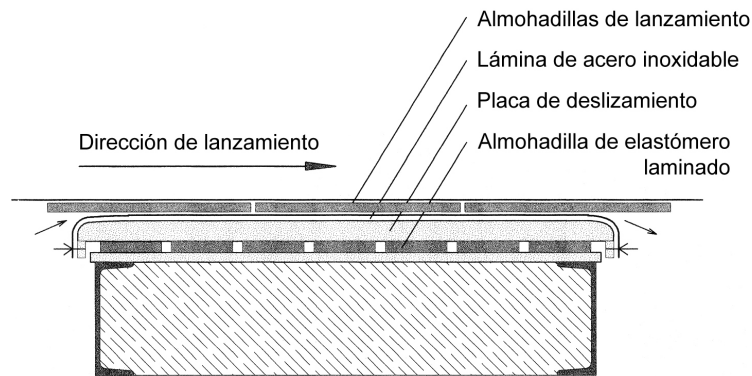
Sección longitudinal de un apoyo de lanzamiento [F14 y elaboración propia].
